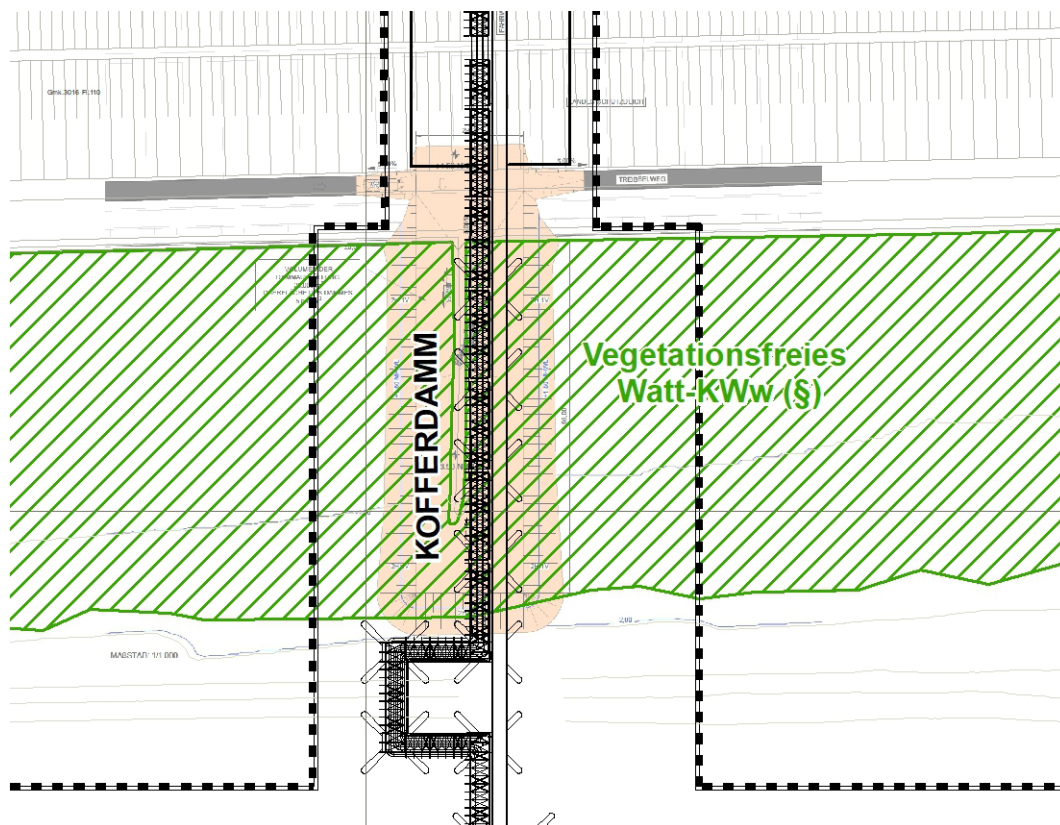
Zufahrt zur Jetty mit Bau eines temporären Kofferdamms durch die gesetzlich geschützte Wattfläche, M 1 : 2.000
